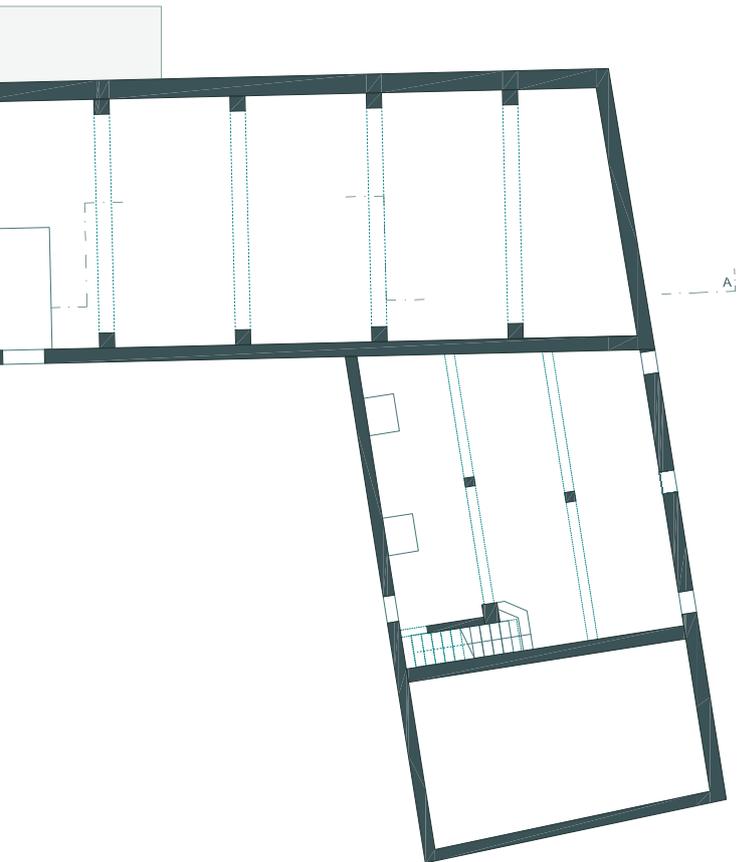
Grundriss Untergeschoß, M = 1:200
